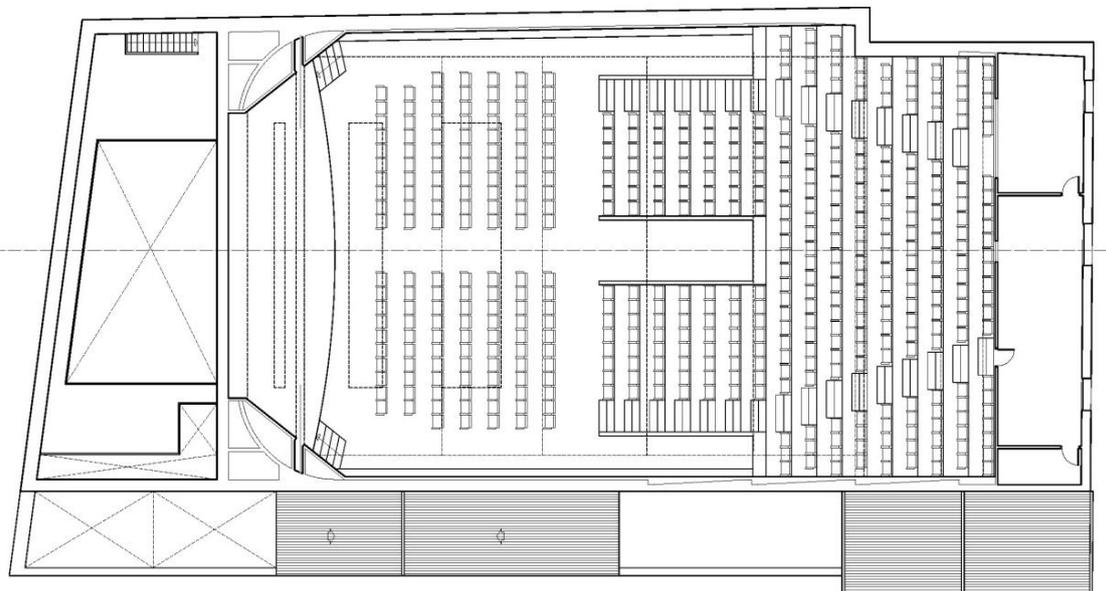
Planta cota primera planta (http://www.arquison.com/p_teatros_auditorios.htm)
